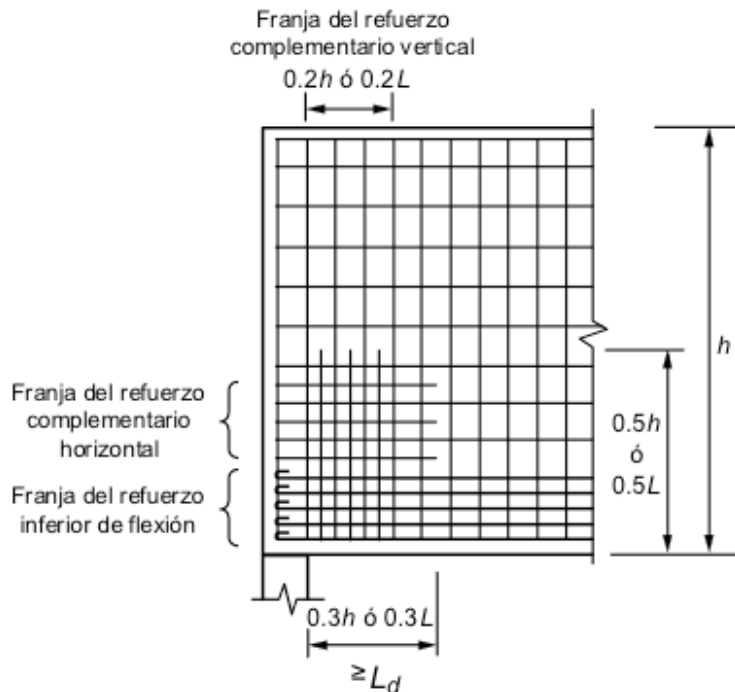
Refuerzo complementario en la zona de apoyo de una viga diafragma no atiesada (modificado de las NTC-C del RCDF, 2004)
